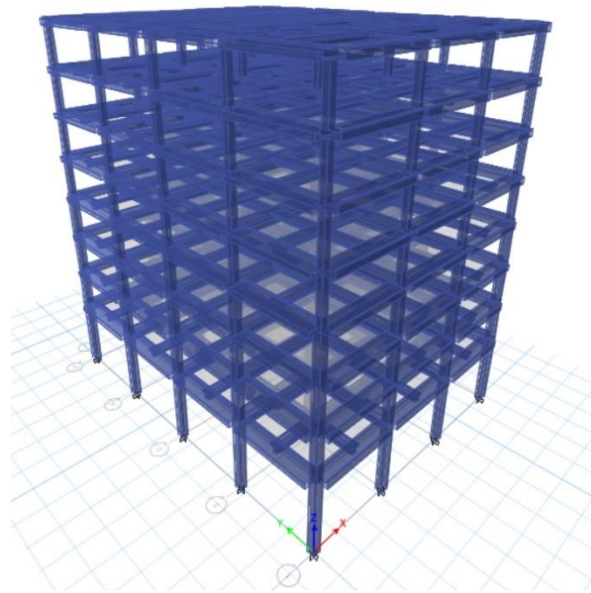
Denah Lantai 1-8 (Model 1-3)
